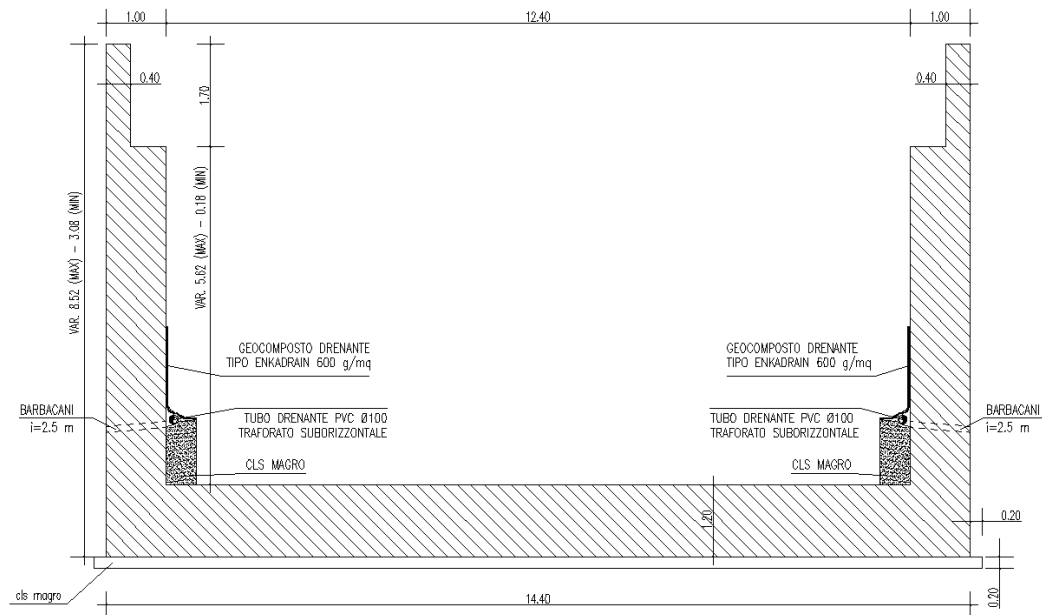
sezione tipo muri ad “U” (conci 1-2-3-4-5-6)
